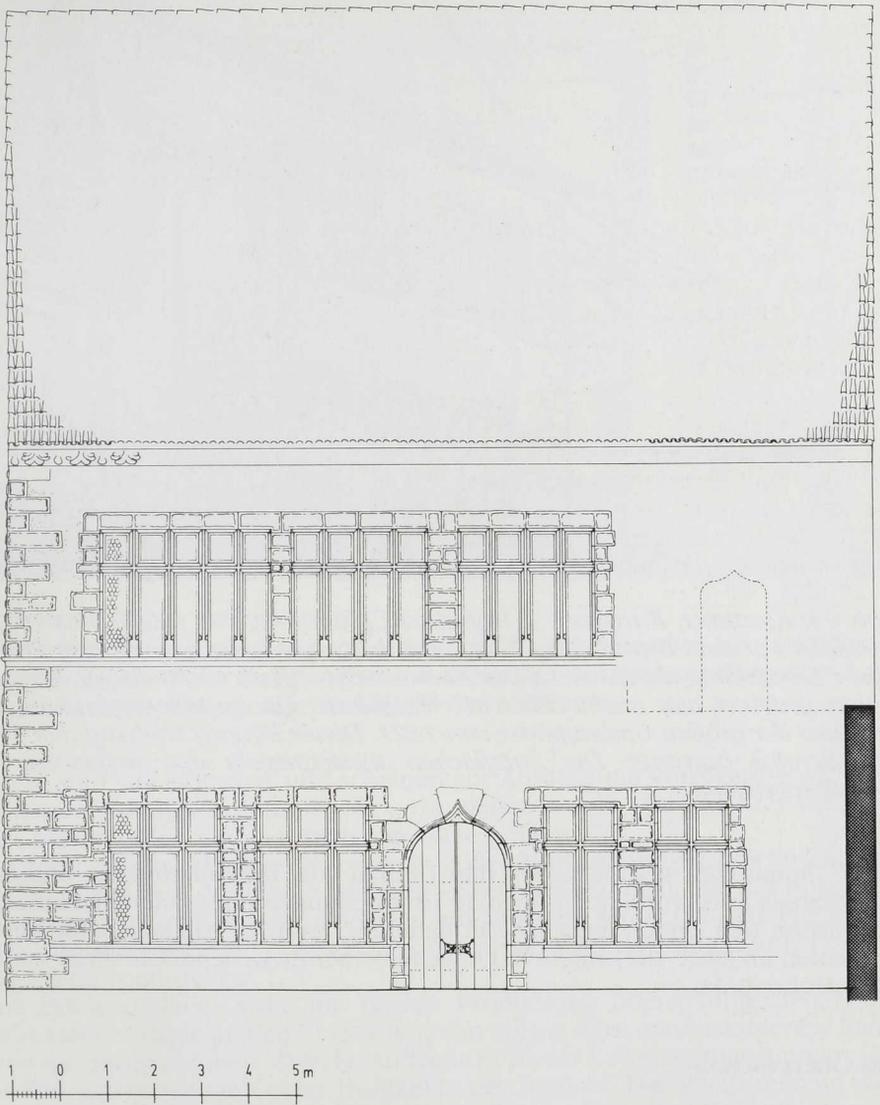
Konstanzer Katzgasse 3. Rekonstruktionsversuch der Hoffassade zur Erbauungszeit.
